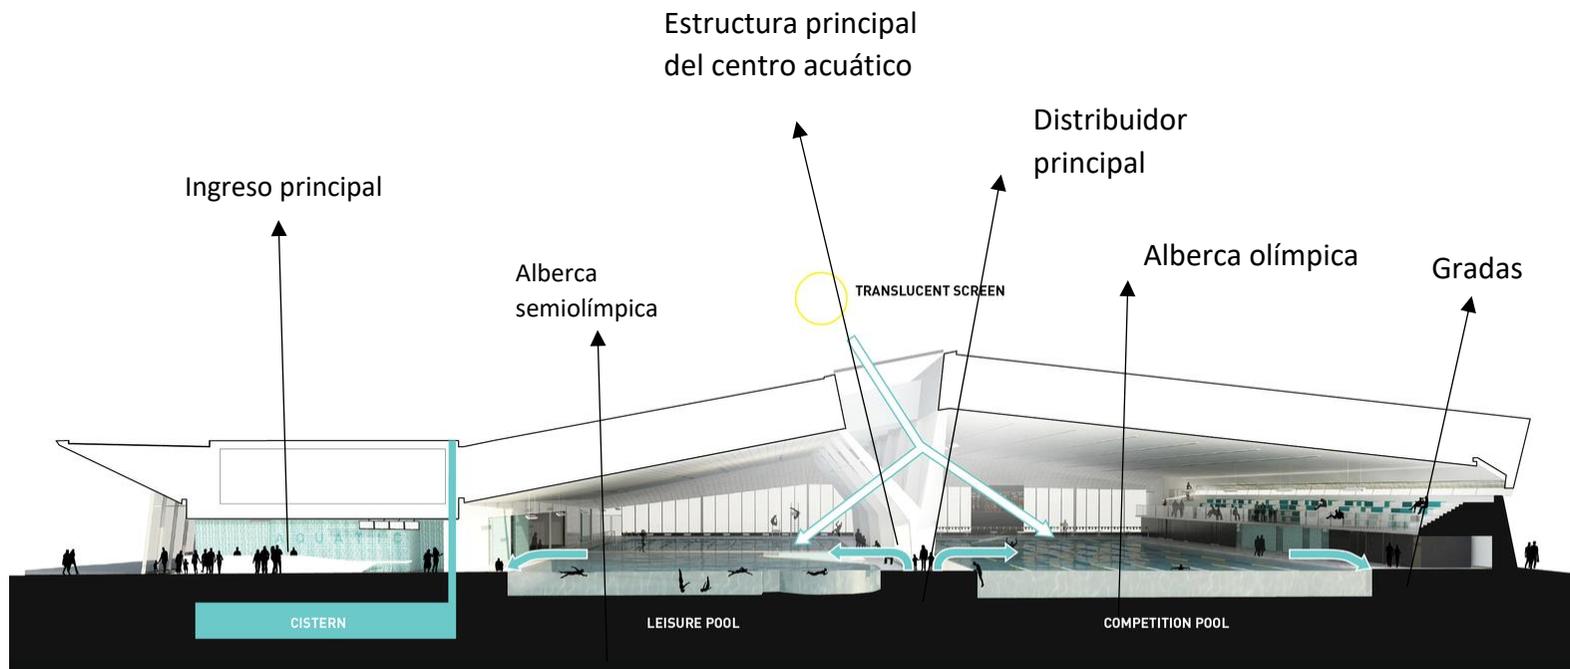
Corte longitudinal (Archdaily, 2018).
